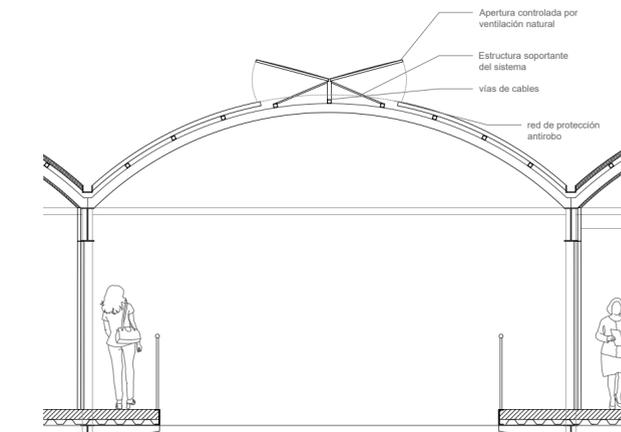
Mecanismo de la cubierta central. Fuente: Elaboración propia
